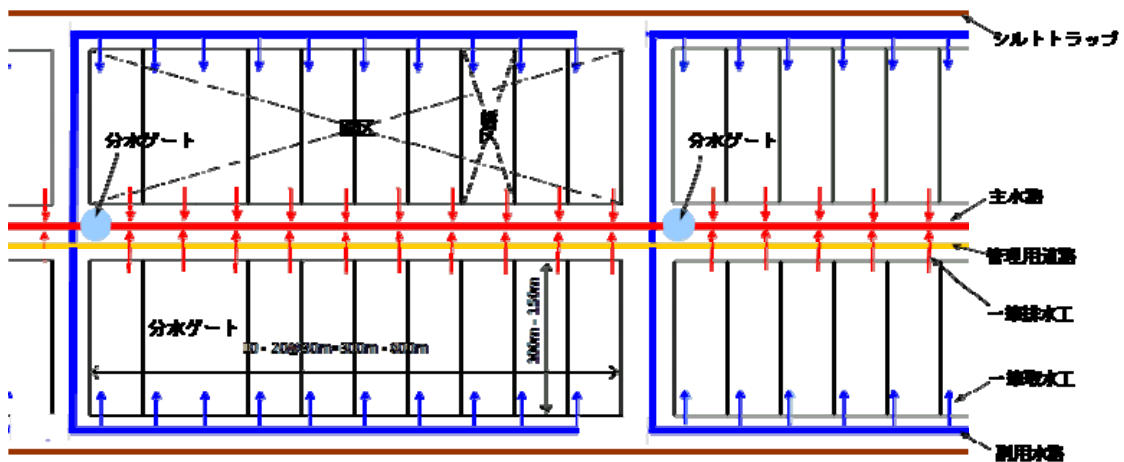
下流既存水田の区画整備計画標準平面図
